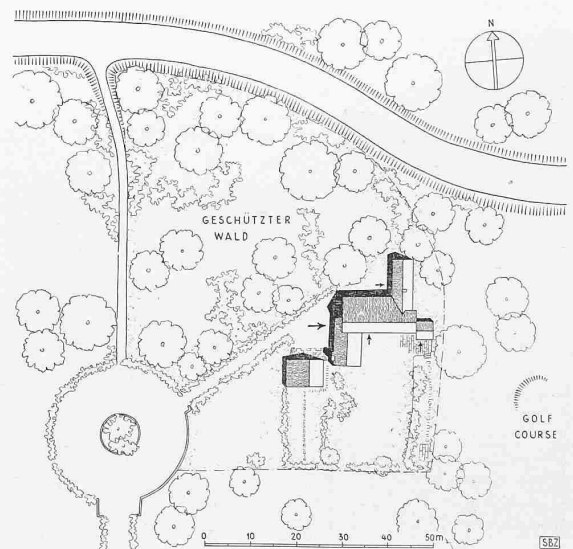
Landhaus in Moor Park, Herts. — Lageplan 1:1500
